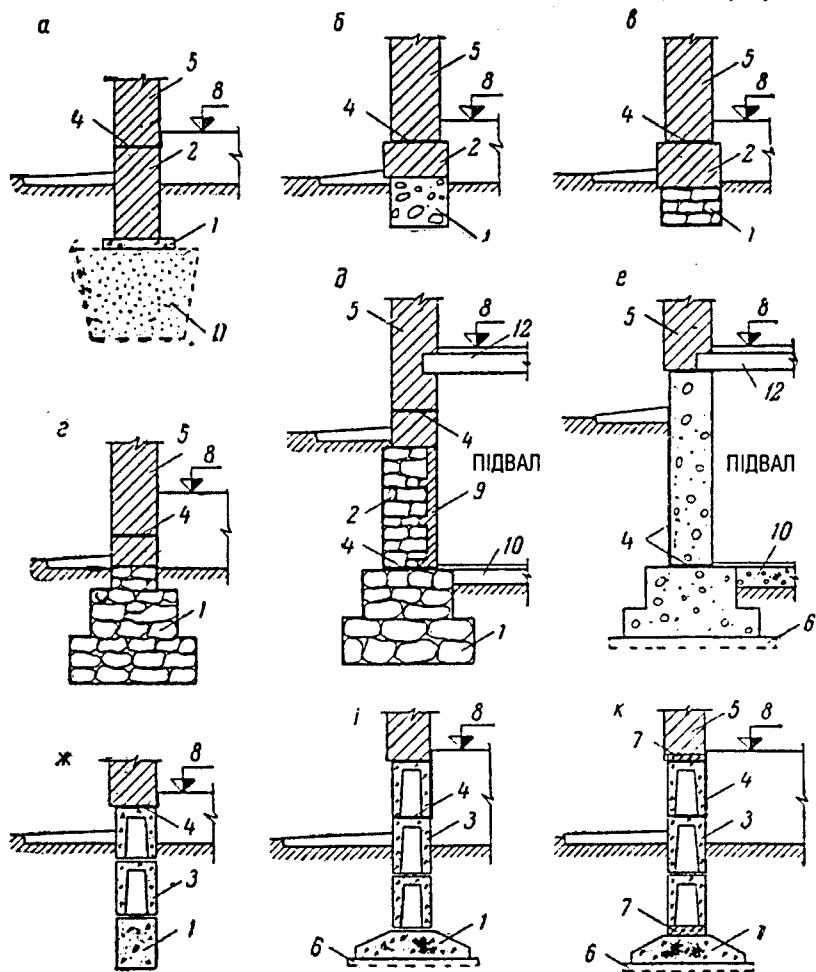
Стрічкові фундаменти: а – на піщаній подушці; б – бутобетонний; в – бутовий; г – бутовий з уступами; д – бутовий у будинку з підвалом; е – бутобетонний у будинку з підвалом; ж, і, к – збірні; 1 – монолітний або збірний фундамент; 2 – фундаментна стіна; 3 – фундаментний стіновий блок; 4 – гідроізоляція; 5 – стіна надземної частини будинку; 6 – шар піску або щебеню товщиною 50-100 мм; 7 – армований пояс; 8 – рівень підлоги першого поверху; 9 – цегляне облицювання; 10 – підлога підвалу; 11 – піщана подушка; 12 – надпідвальне перекриття.
